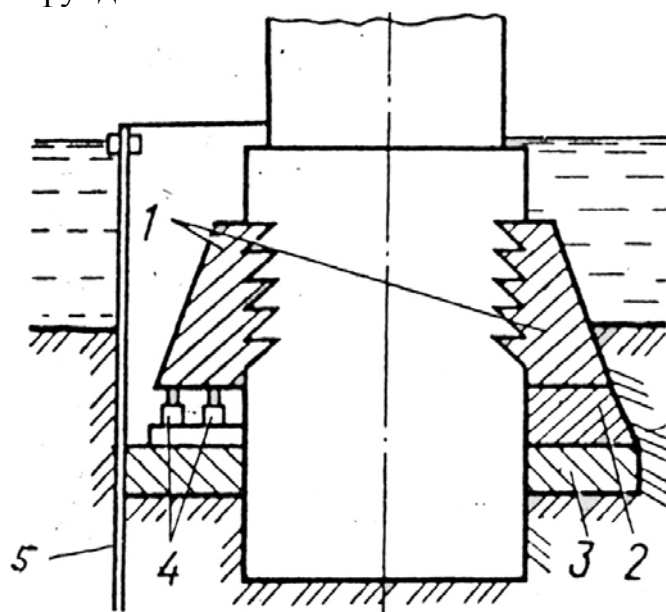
Усиление фундамента опоры путем его уширения: 1 – мощные железобетонные консоли; 2 – забетонированный просвет; 3 – опорная железобетонная плита; 4 – гидравлические домкраты; 5 – шпунт
